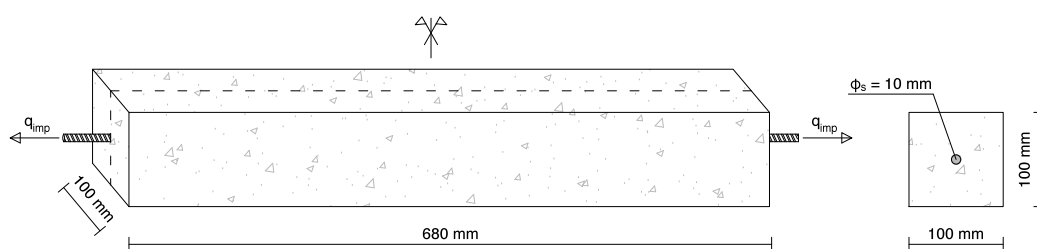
Configuração do ensaio elaborado por Clément [36] (adaptado de Mendes [20])
